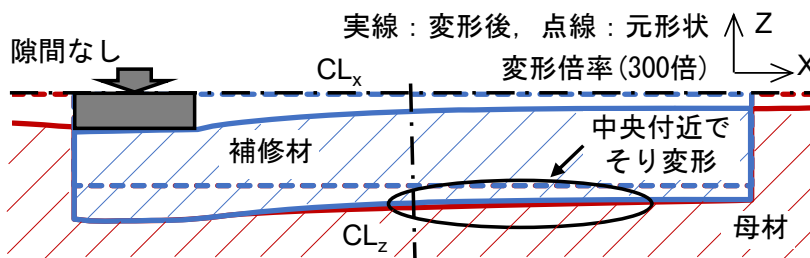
b-b 断面における開口挙動の概略図 (ケース 1, 隙間なし)
